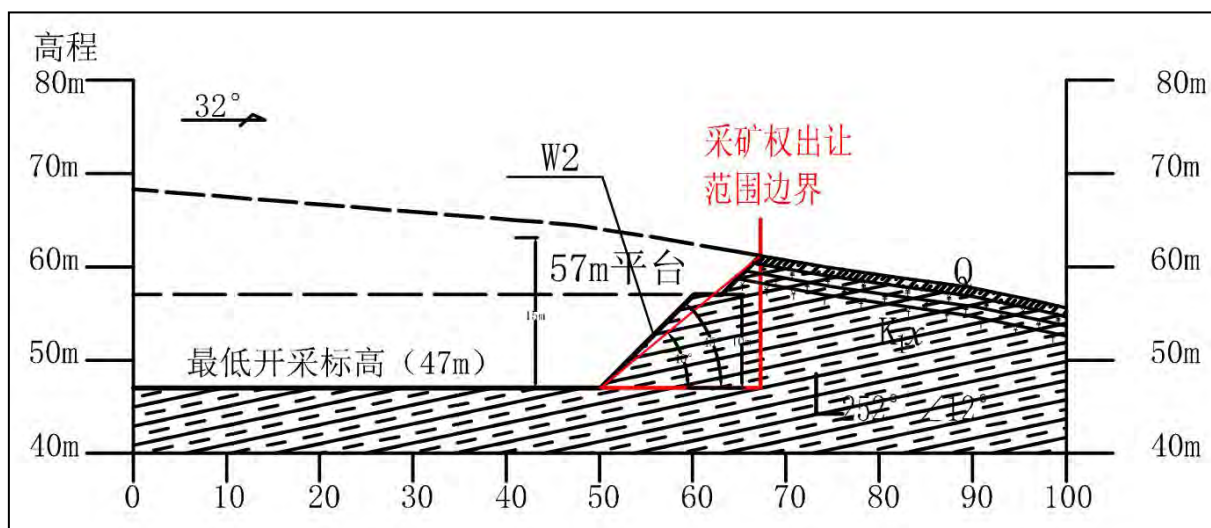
露天采场典型边坡 W2 工程地质剖面图
